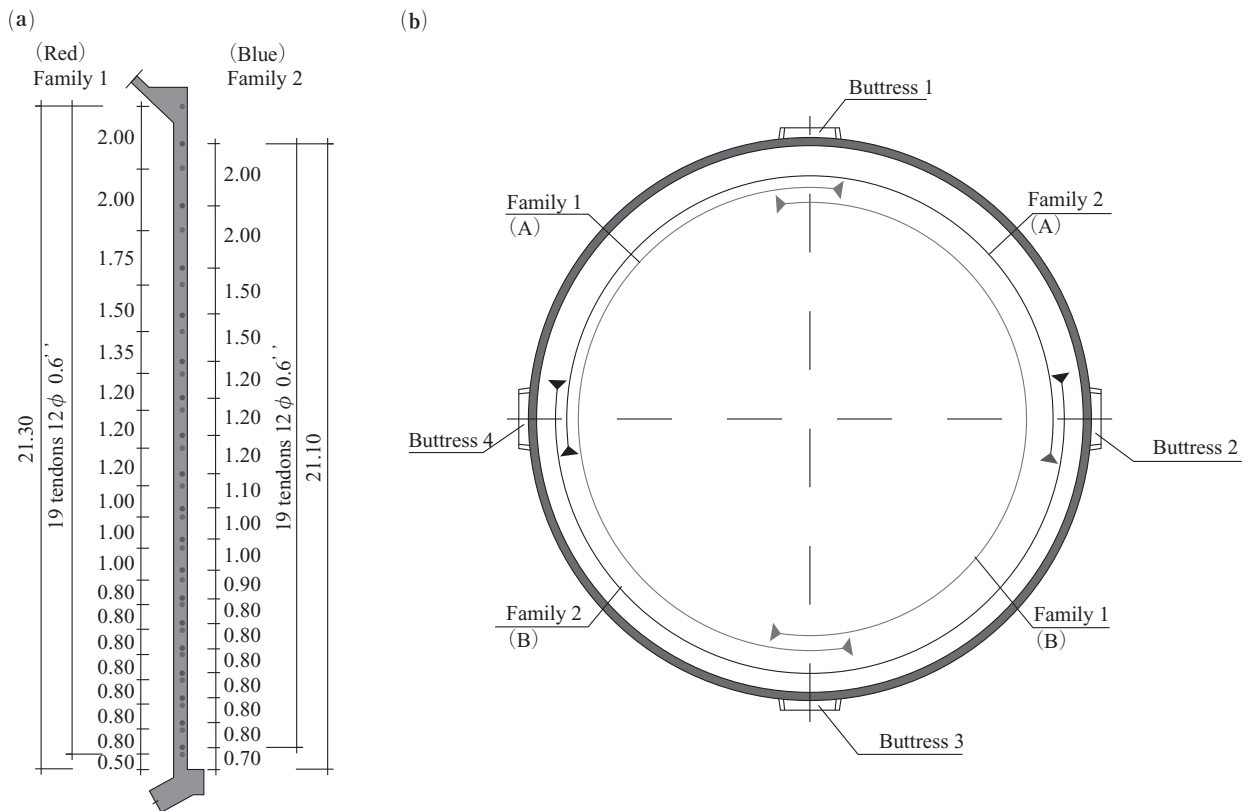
円周方向のポストテンションシステム詳細図, 配置図 (単位 : m)
